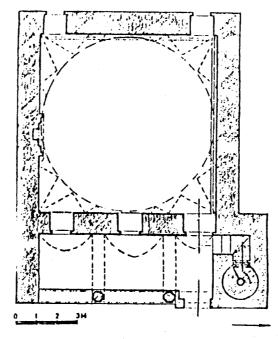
مسقط أفقي لجامع وقبة الشيخ خراسان في ازربيجان . (عن : Bretanizki) .
